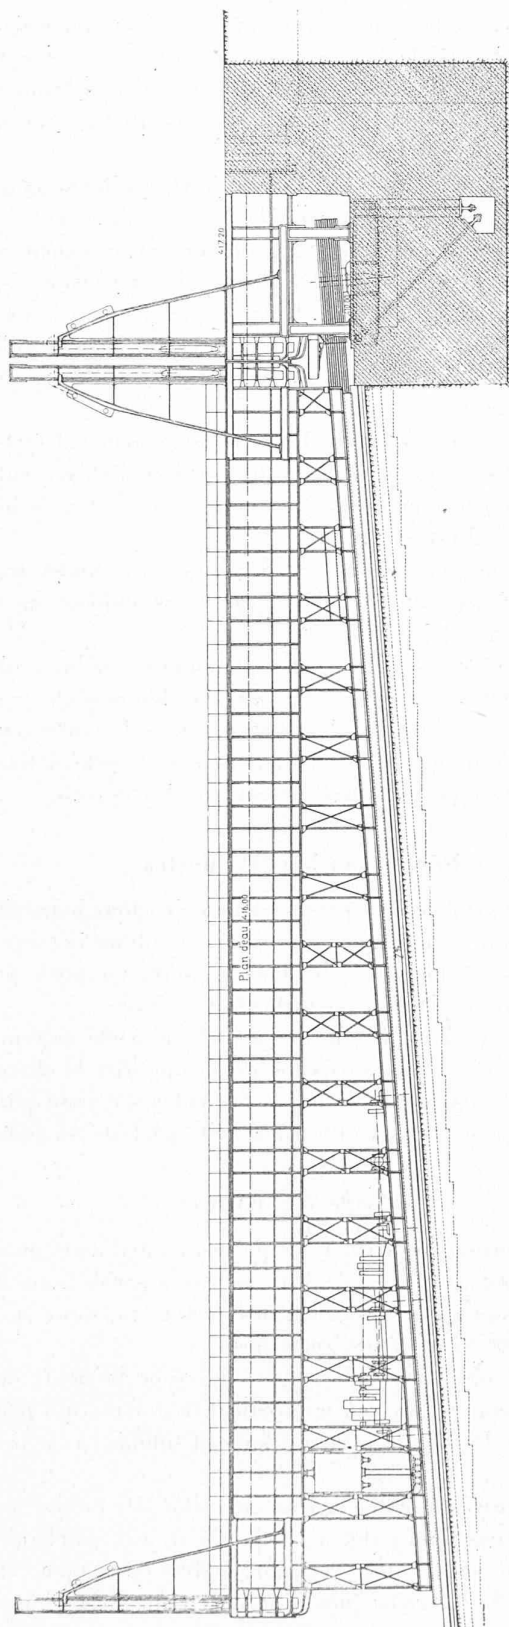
Plans inclinés : installation de la partie supérieure. — 1 : 400.
